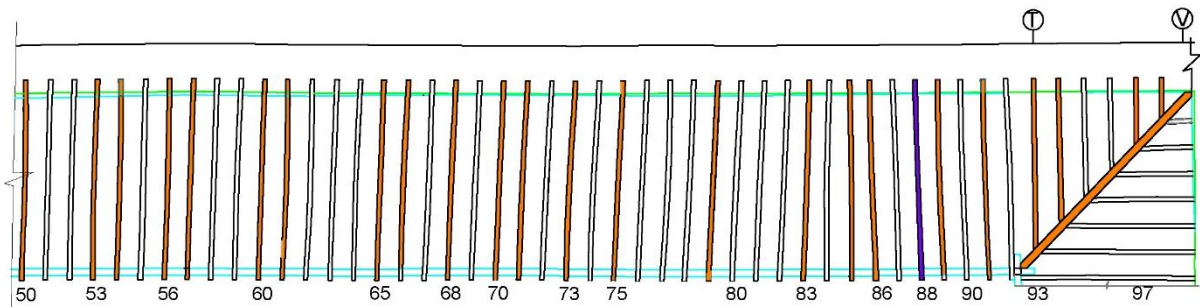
Propuesta de solución al forjado entre vigas 50-98
